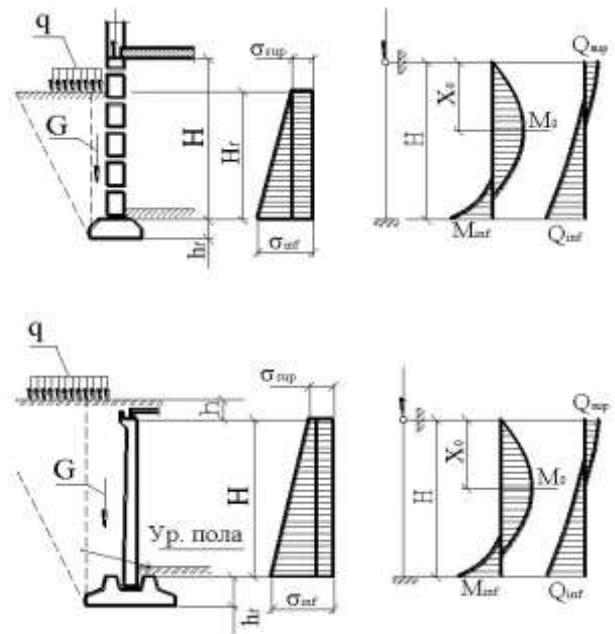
К определению расчетных усилий в стенах подвалов:
